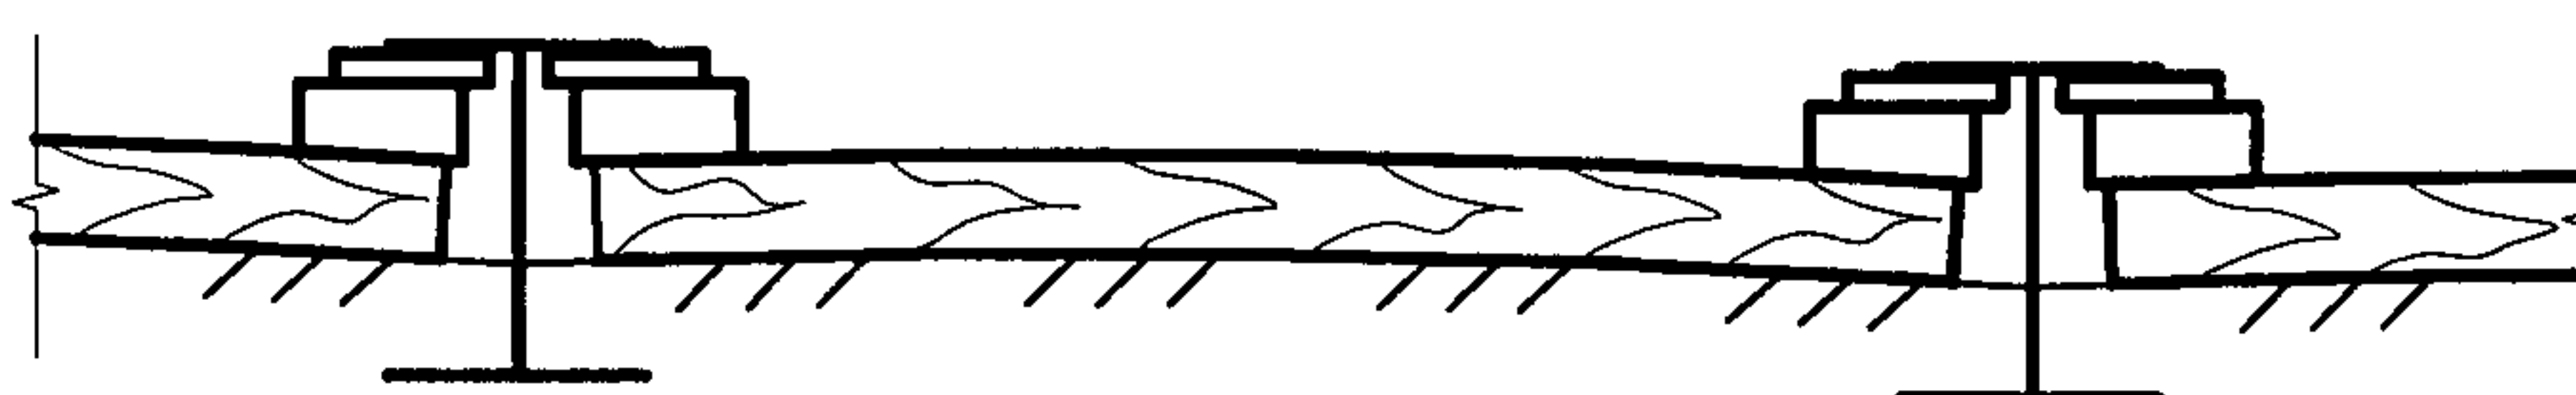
Закладное крепление из металлических двутавровых свай.
